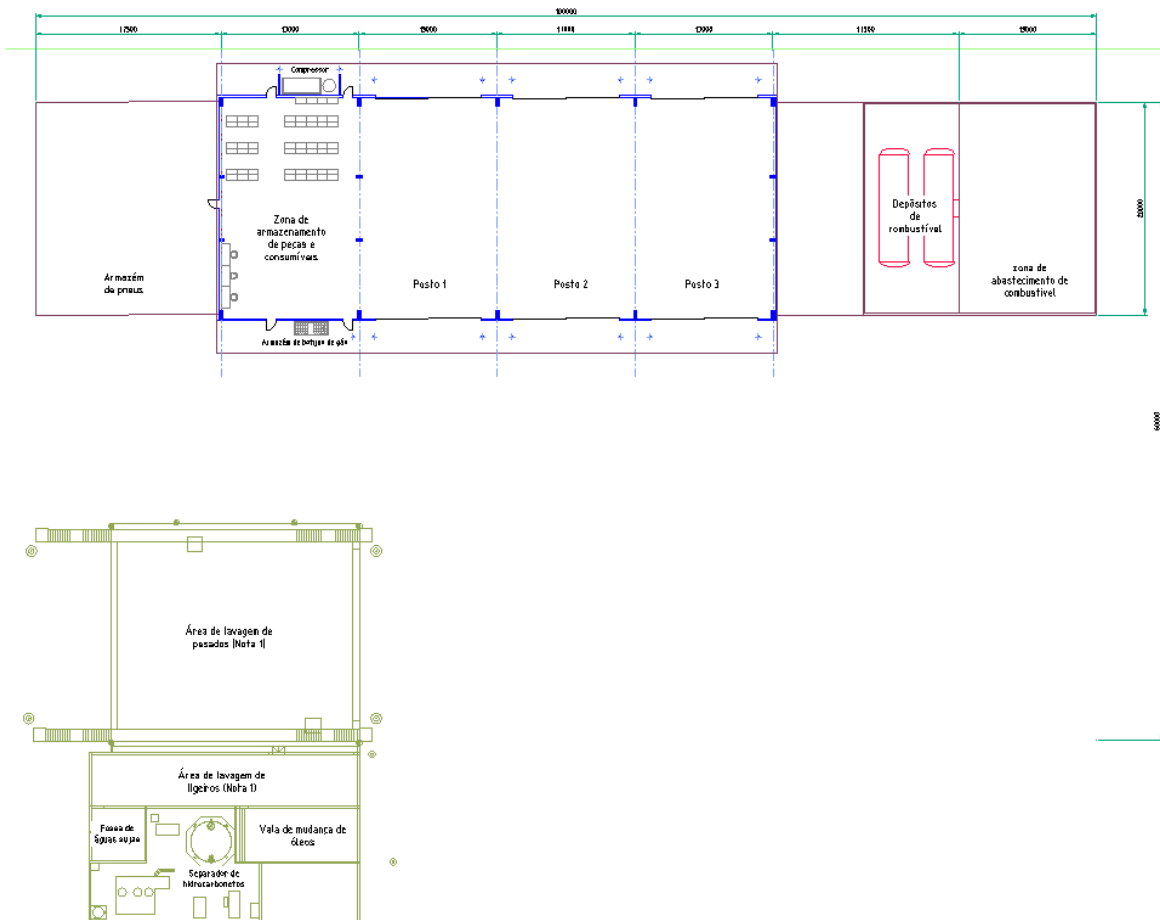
Disposição e planta da Oficina de Equipamentos Móveis.
